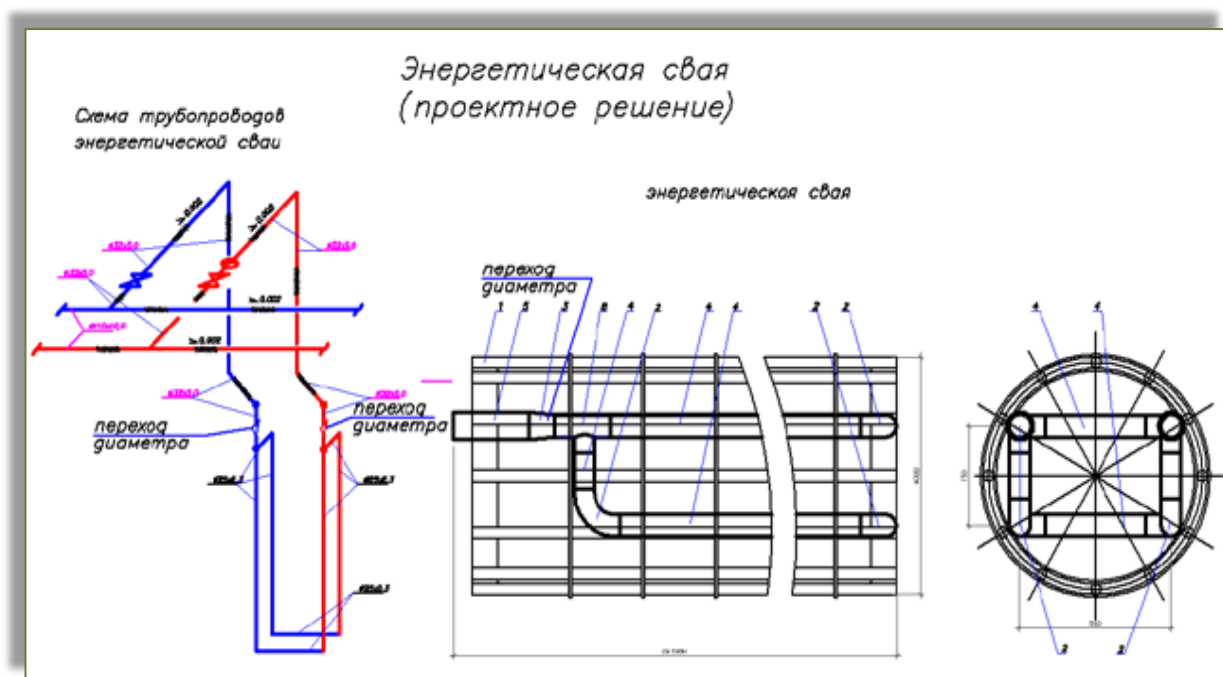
Принципиальная схема теплового насоса, снимающего низкопотенциальную энергию с фундаментных свай здания
